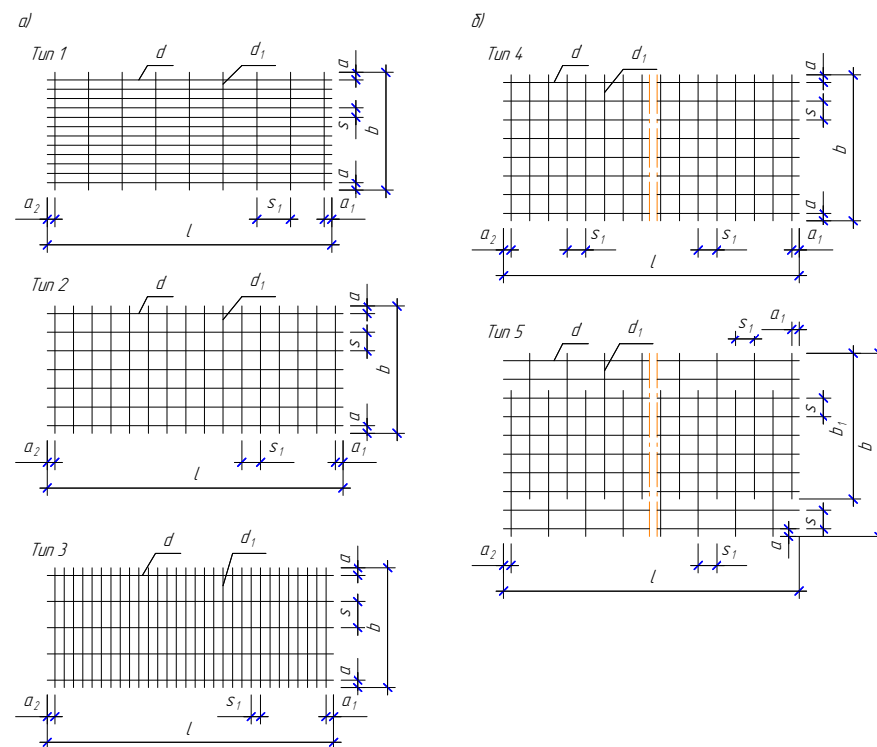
Типы сварных сеток: а – тяжёлые сетки; б – лёгкие сетки.
